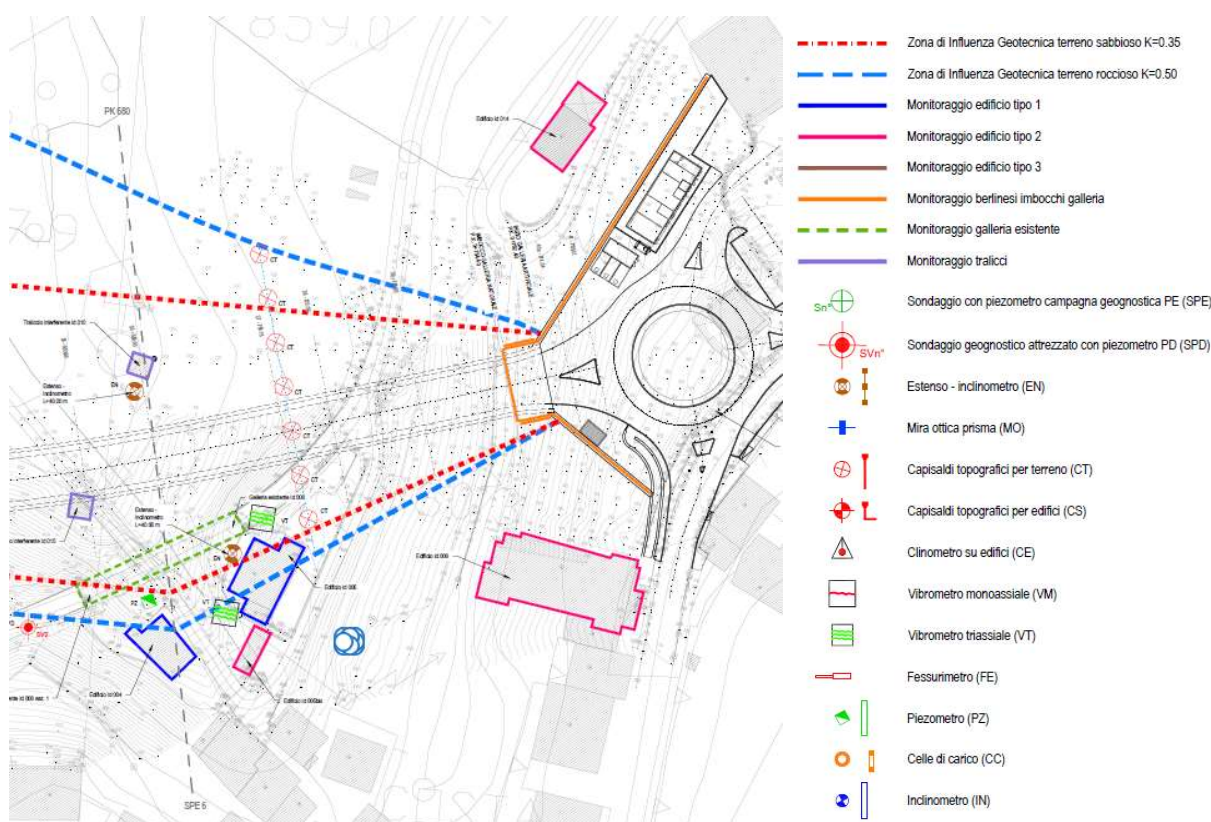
Stralcio planimetria ubicazione strumentazione di monitoraggio
